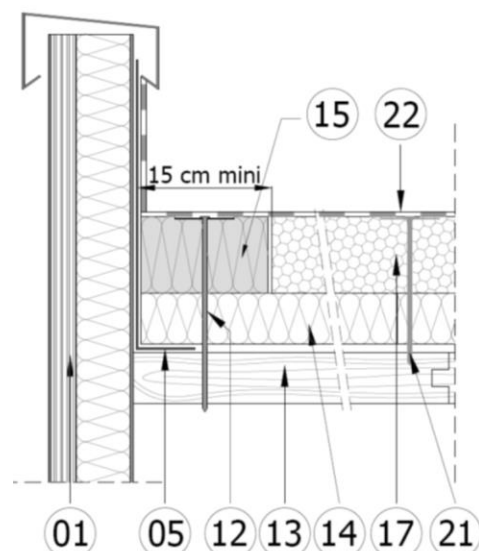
Exemple de calfeutrement horizontal contre un mur
